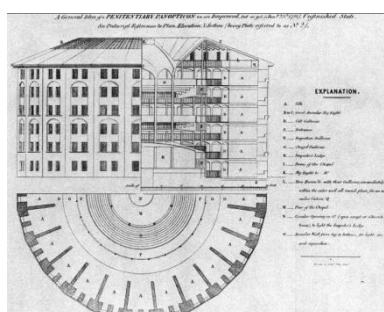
Panóptico, 1791, J. Bentham, (Alçado/corte parcial, e Planta)
